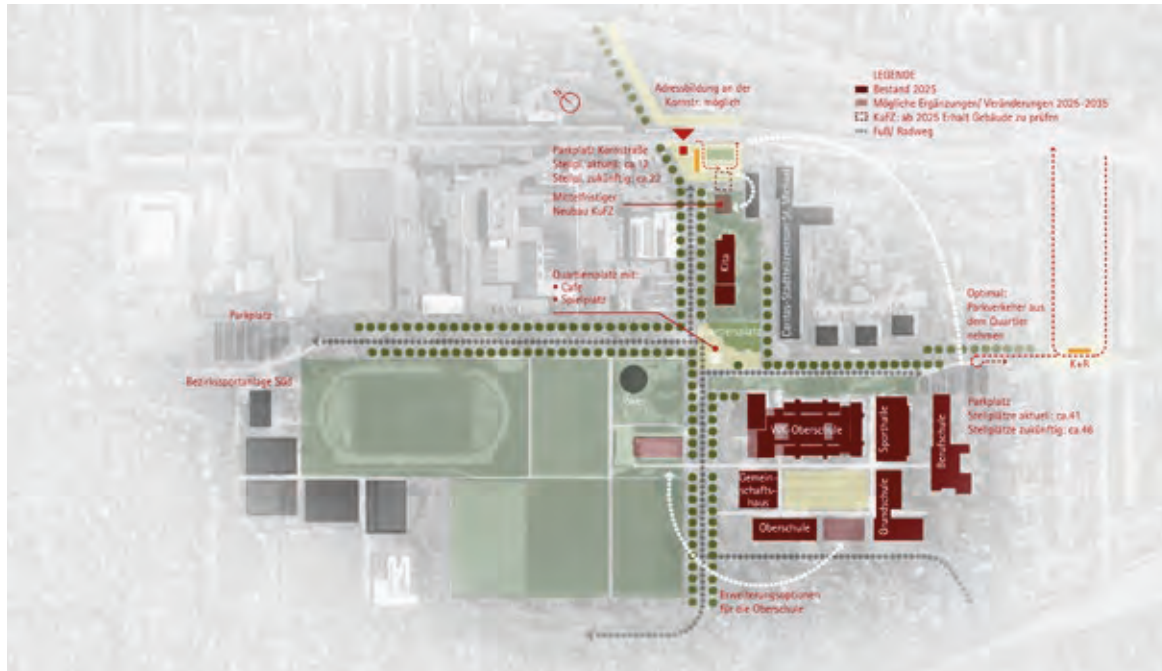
Masterplan Kaisen-Campus: Ausbau der Oberschule, Neubau von Grundschule und Sporthalle (gmp)
